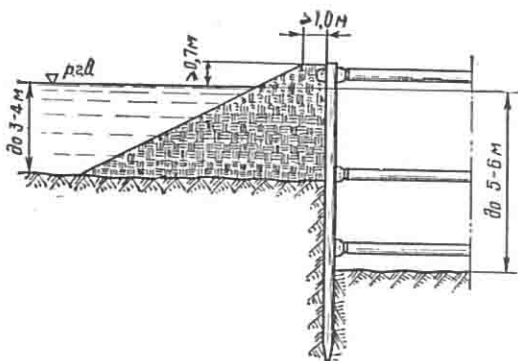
Однорядная деревянная шпунтовая перемычка с грунтовым откосом
